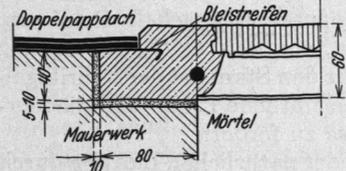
Anschluß eines Doppelpappdaches an ein eingelegtes Glasbeton-Dachoberlicht.
